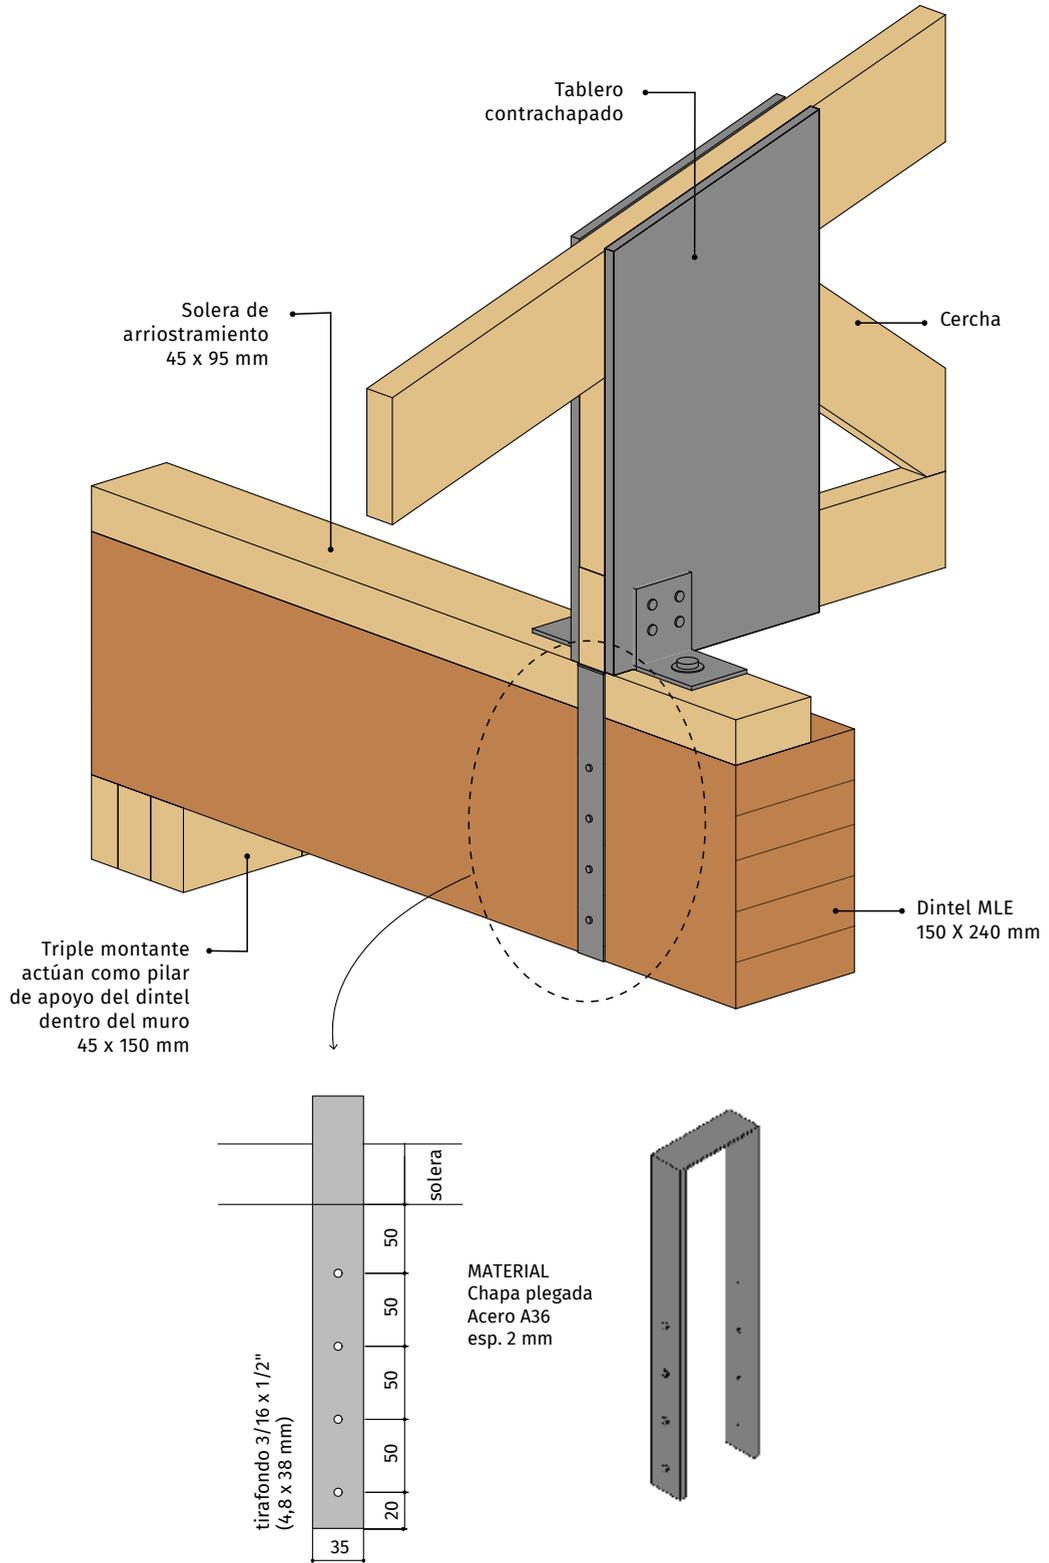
Detalle de apoyo de cercha sobre dintel de madera laminada
